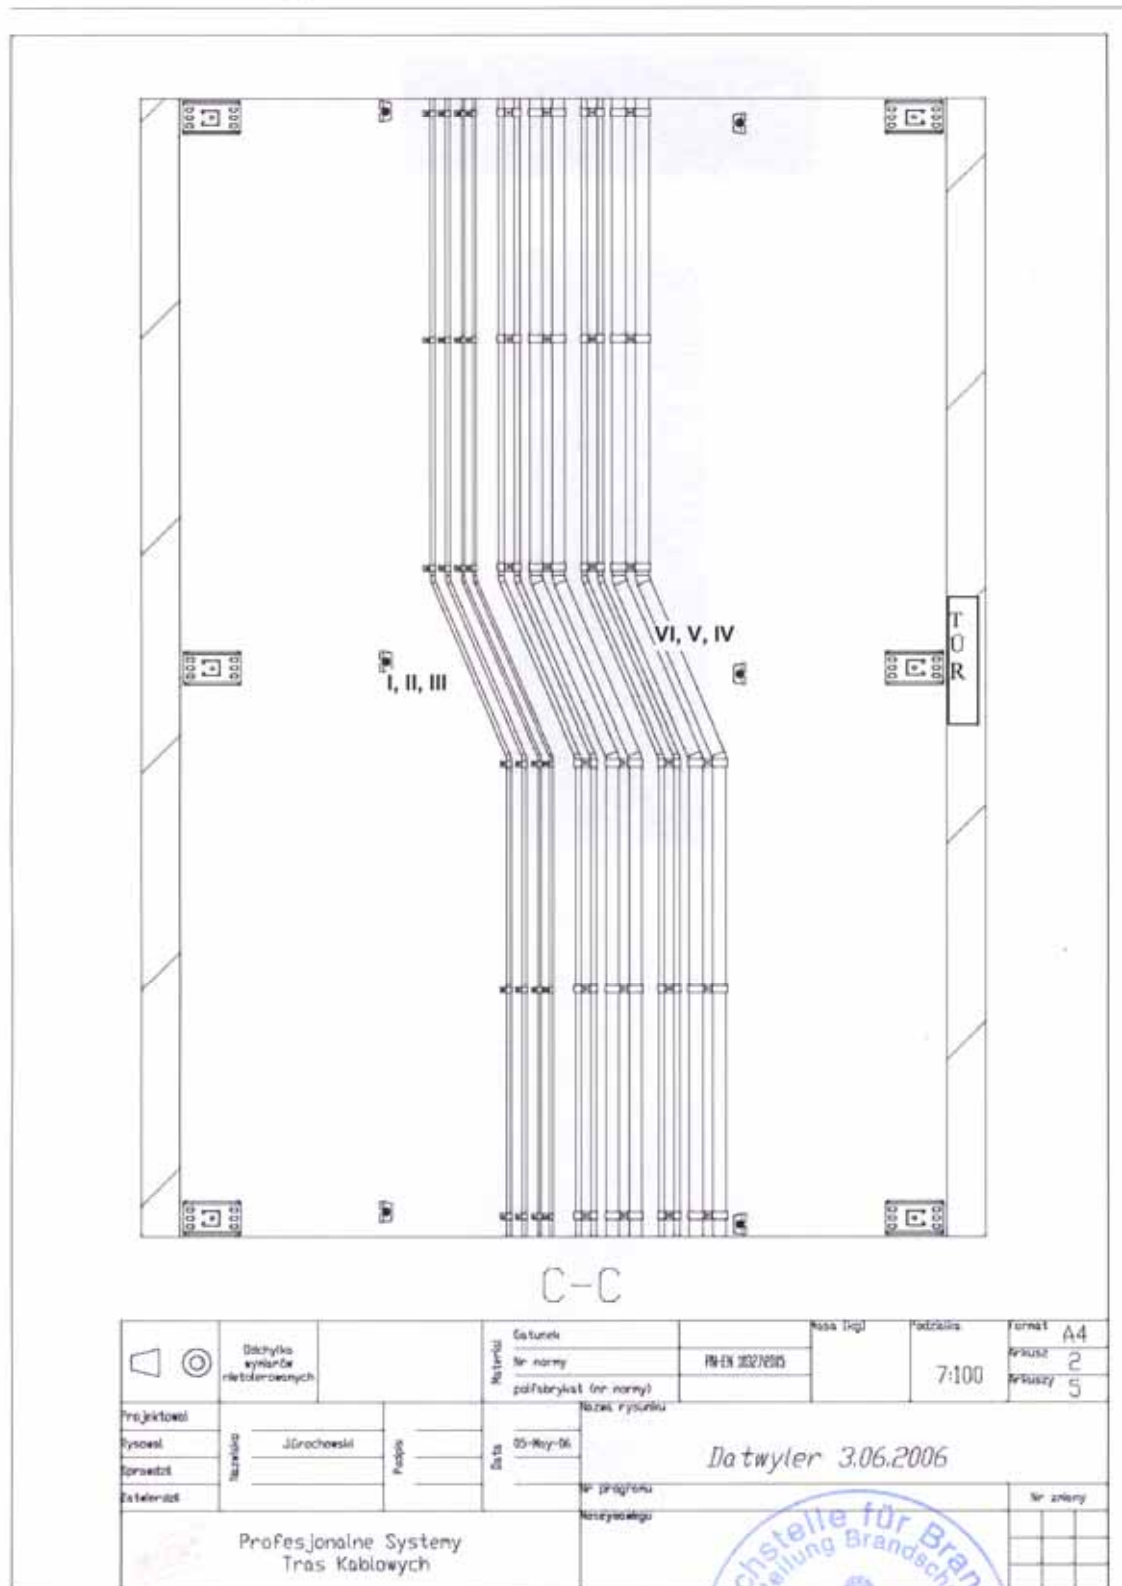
Lage der Thermoelemente im Grundriss
